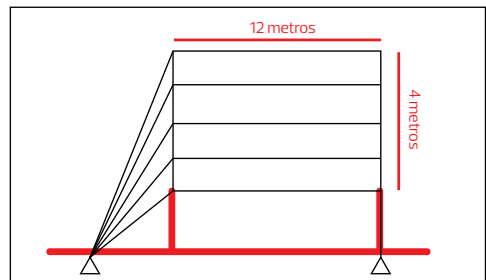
Sección de un plano típico, rectangular de atrapaniebla (Soto, 1992)
